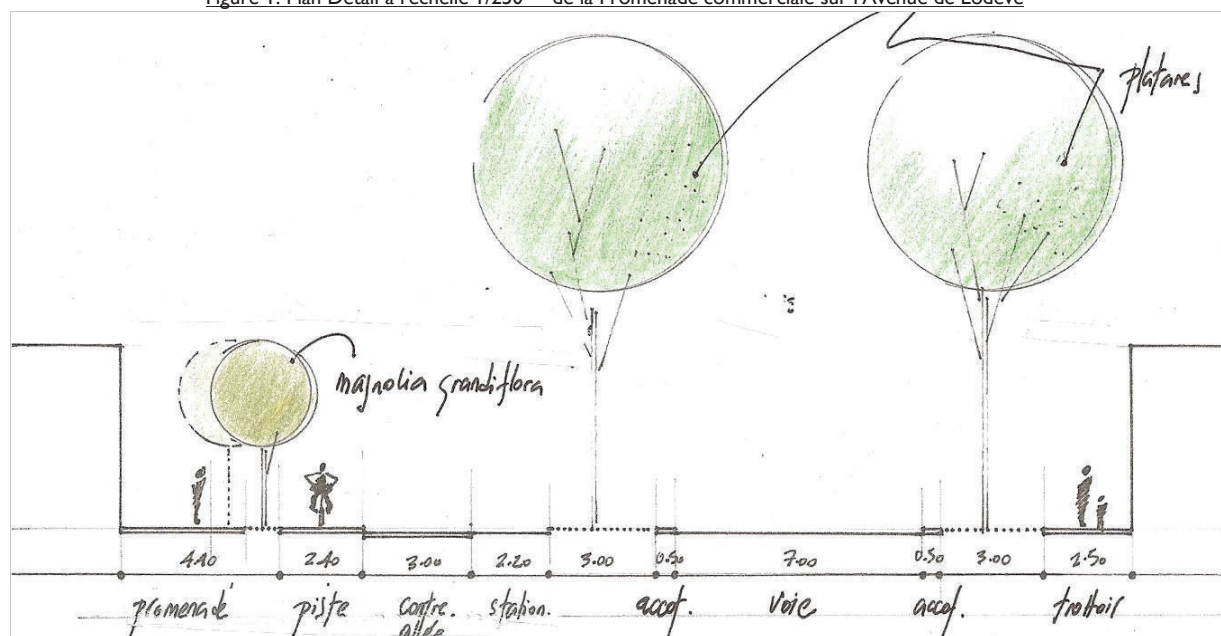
Plan Détail à l'échelle 1/250^{ème} de la Promenade commerciale sur l'Avenue de Lodève
